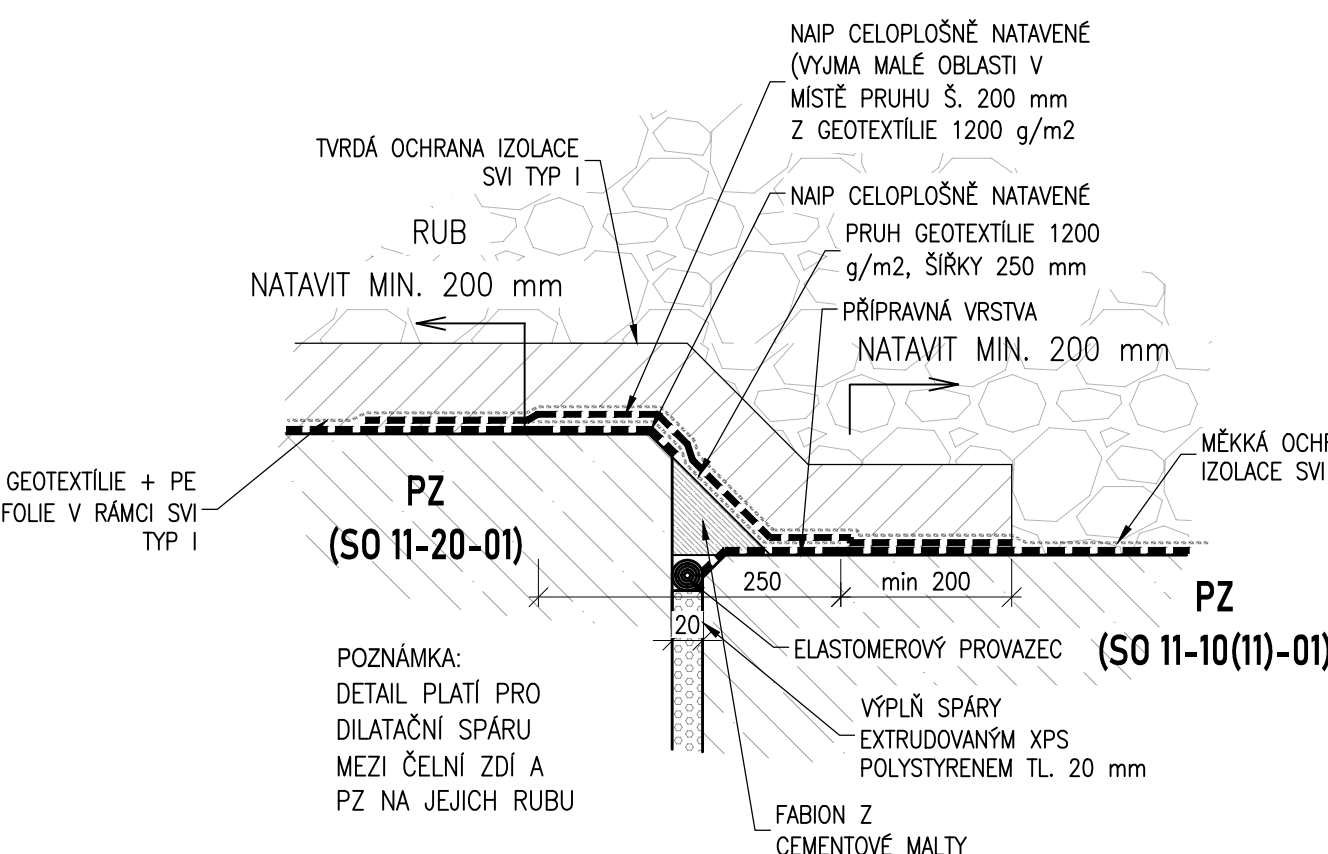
PŘECHOD IZOLACE Z NK NA SPÁDOVÝ BETON
